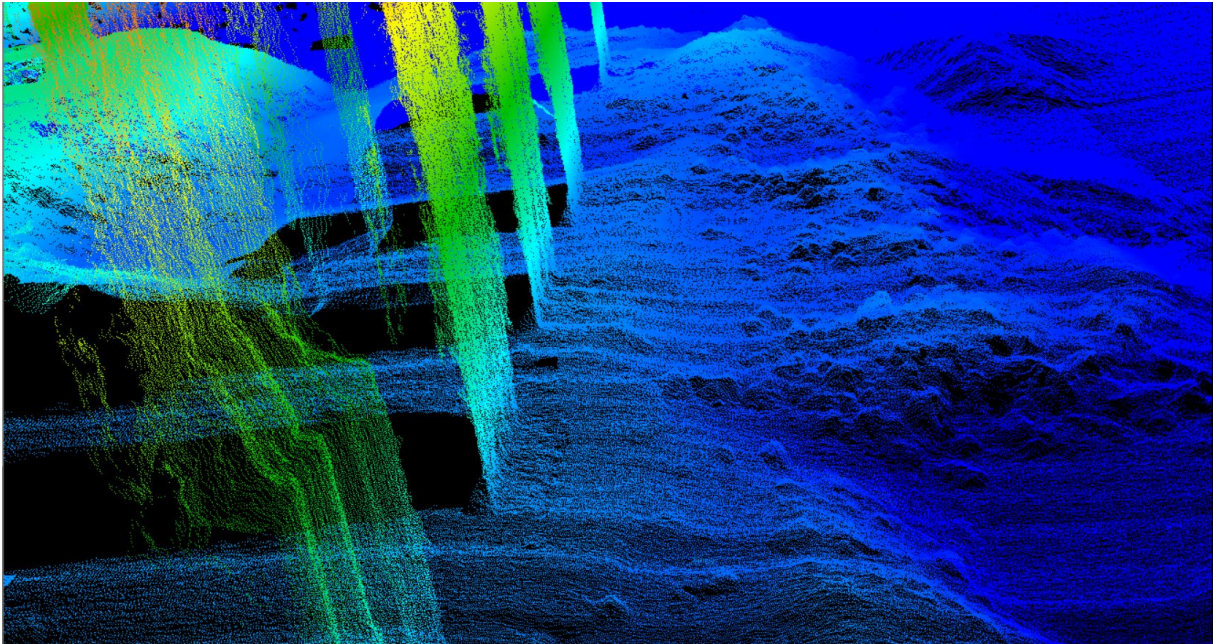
Cimentación y paramentos frontales de pilas (P5 en primer plano).
